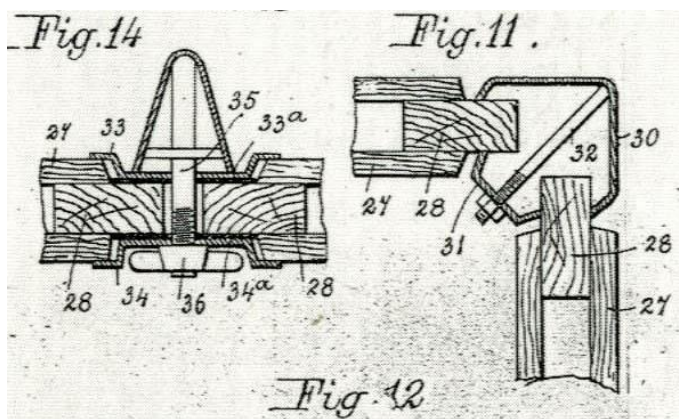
Assemblages des panneaux des baraquements militaires de 1940
